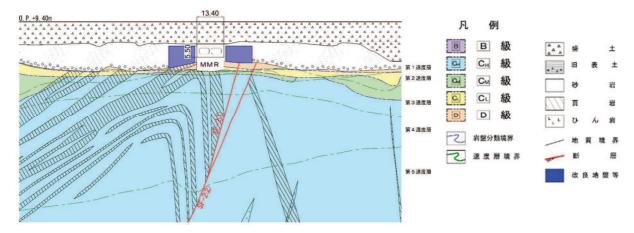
地盤改良体の配置図(取水路, B-B 断面)
